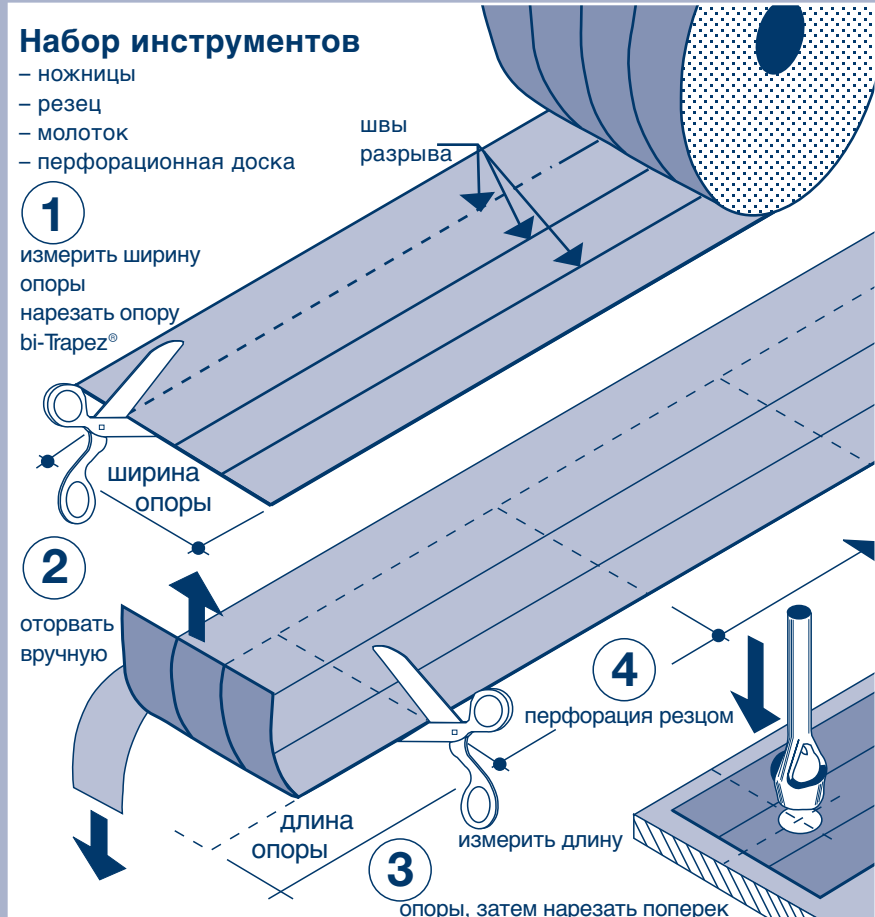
Нарезка рулона опоры bi-Trapez® фирмы «Calenberg» на месте
